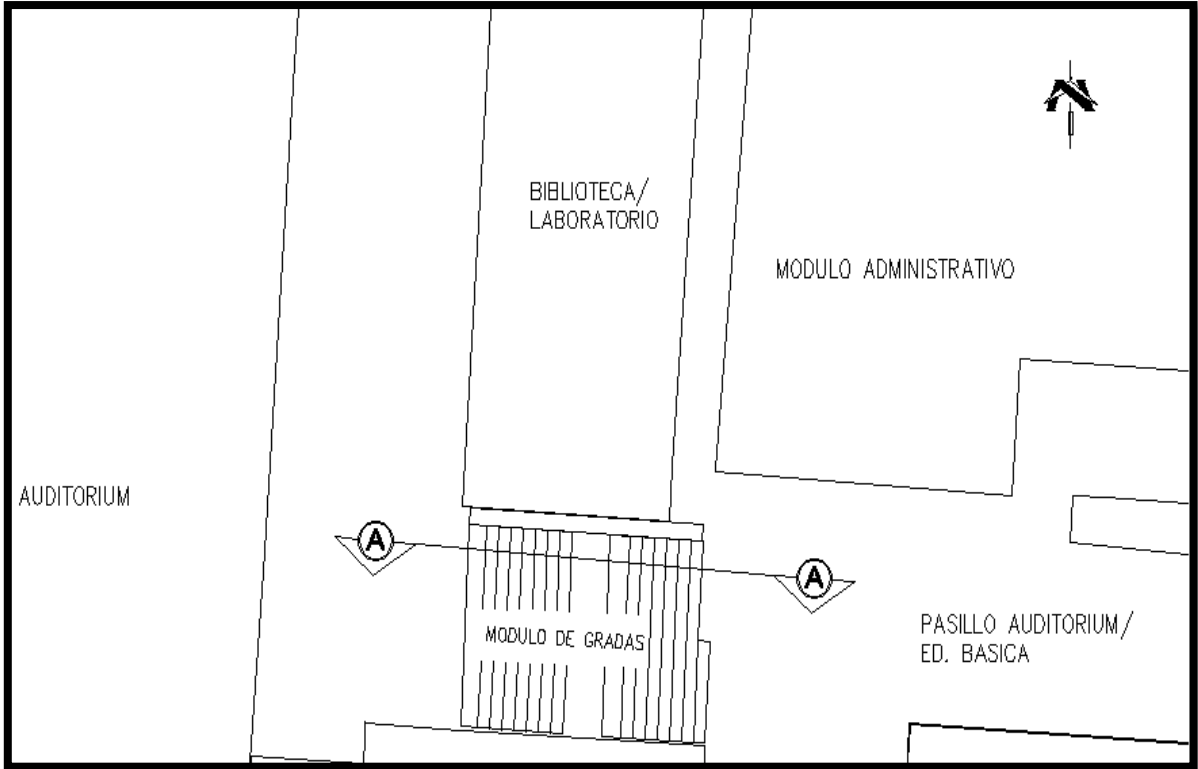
24 “Vista en planta del sector circulación hacia el Auditorium”
